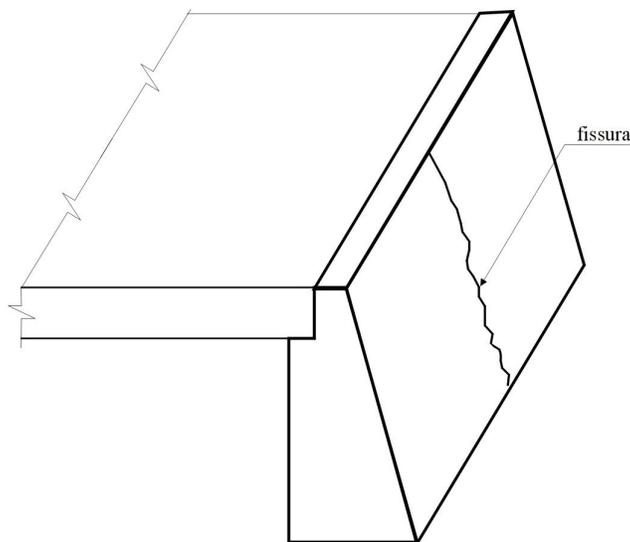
Fissuras de tração em encontros de pontes em alvenaria de pedra ou concreto ciclópico
